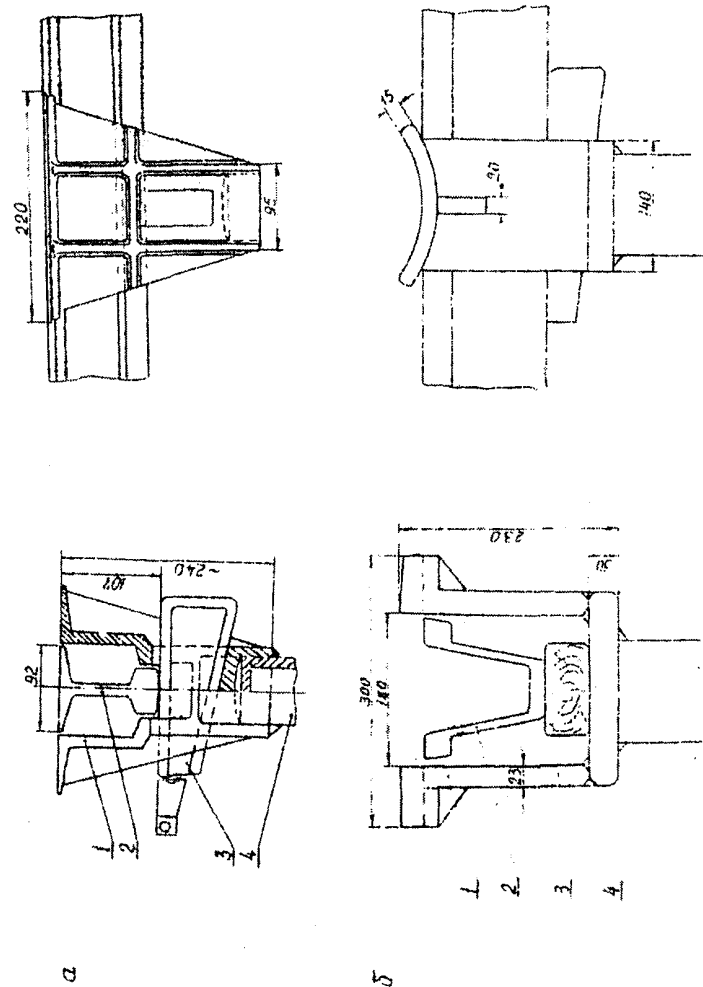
Конструкция снегозащит: 0 - снегозащитная балка под рельс Р-24 с металлическими поперечными клином; 1 - корпус инвентарной крепи; 2 - верхняк (рельс Р-24 или специальный СВИ-27); 3 - клин; 4 - выдвигаемая часть стойки
